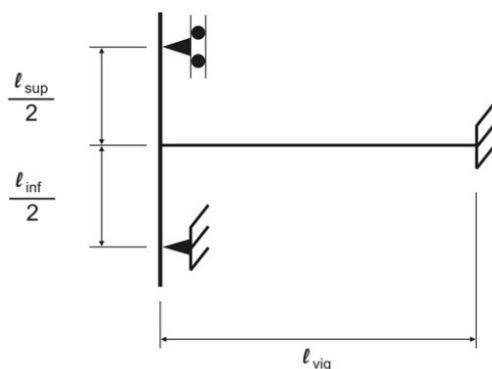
Esquema adotado para a modelagem dos pilares (NBR 6118 /14)
